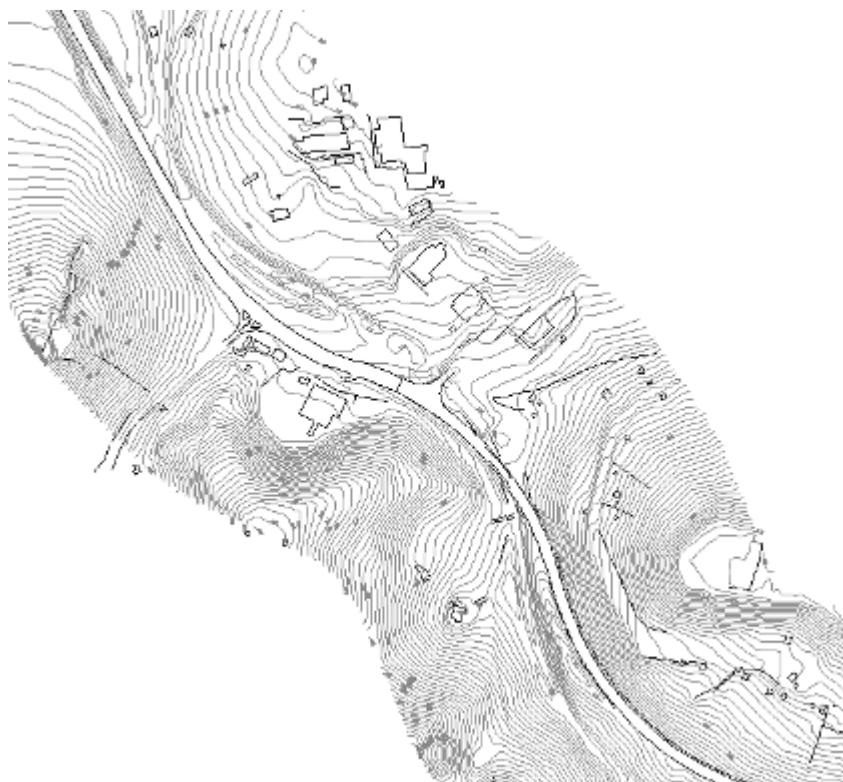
Planimetria stato attuale presso lo svincolo di Bonorva nord al km 162
